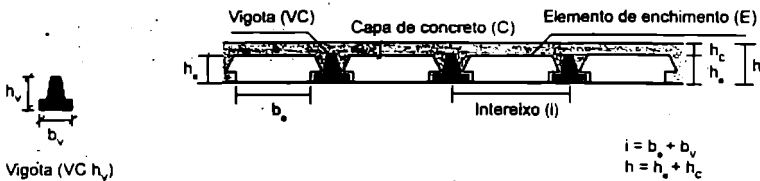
Laje pré-fabricada com vigotas de concreto armado (LC).
